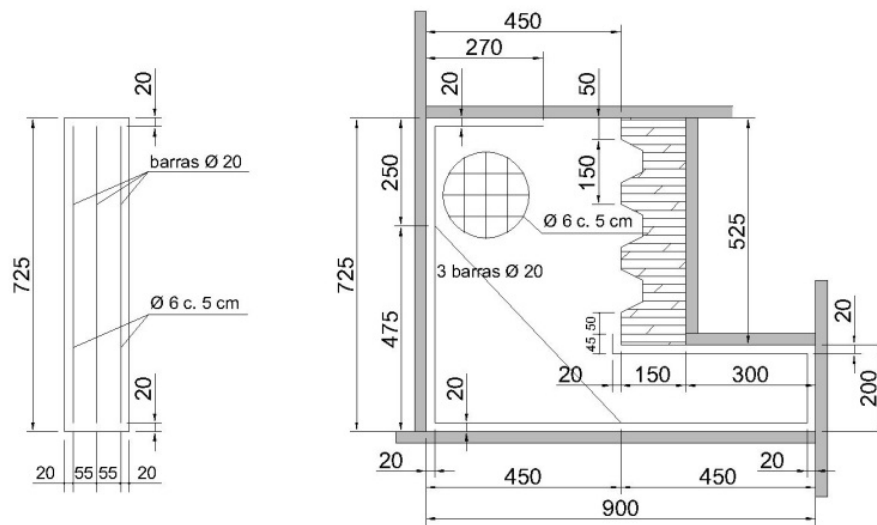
Disposición de las barras y mallas electrosoldadas para la fabricación de las piezas de hormigón en el perfil (izquierda) y encofrado para la primera pieza (derecha) para la junta de tres llaves (cotas en mm)
